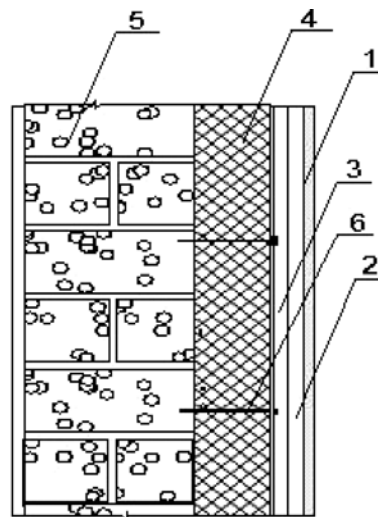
Отделка с использованием скрепленной системы теплоизоляции: 1 – декоративно-защитный слой, 2 – грунтовка, 3 – гидрозащитный слой, армированный стеклосеткой, 4 – теплоизоляция, 5 – кладка из газобетонных блоков, 6 – тарельчатые пластмассовые дюбеля
